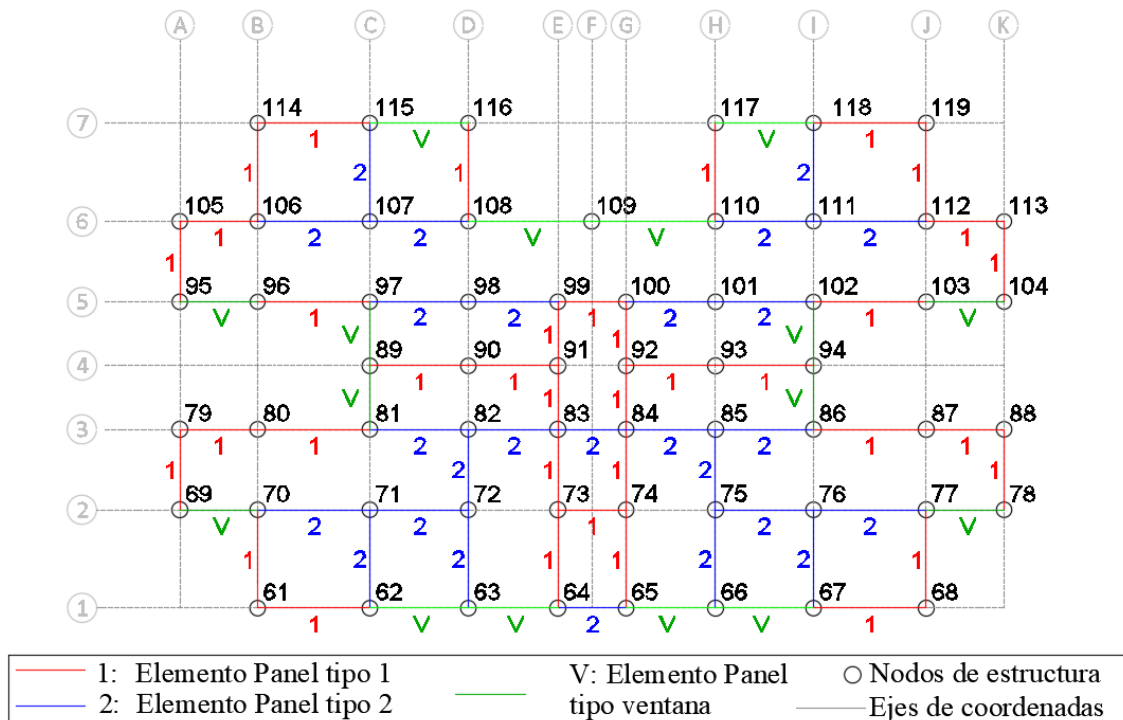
Vista en planta del nivel 1 del modelo digital del bloque 11 de San Fernando para muros de mampostería tipo 1, 2 y Ventanas
